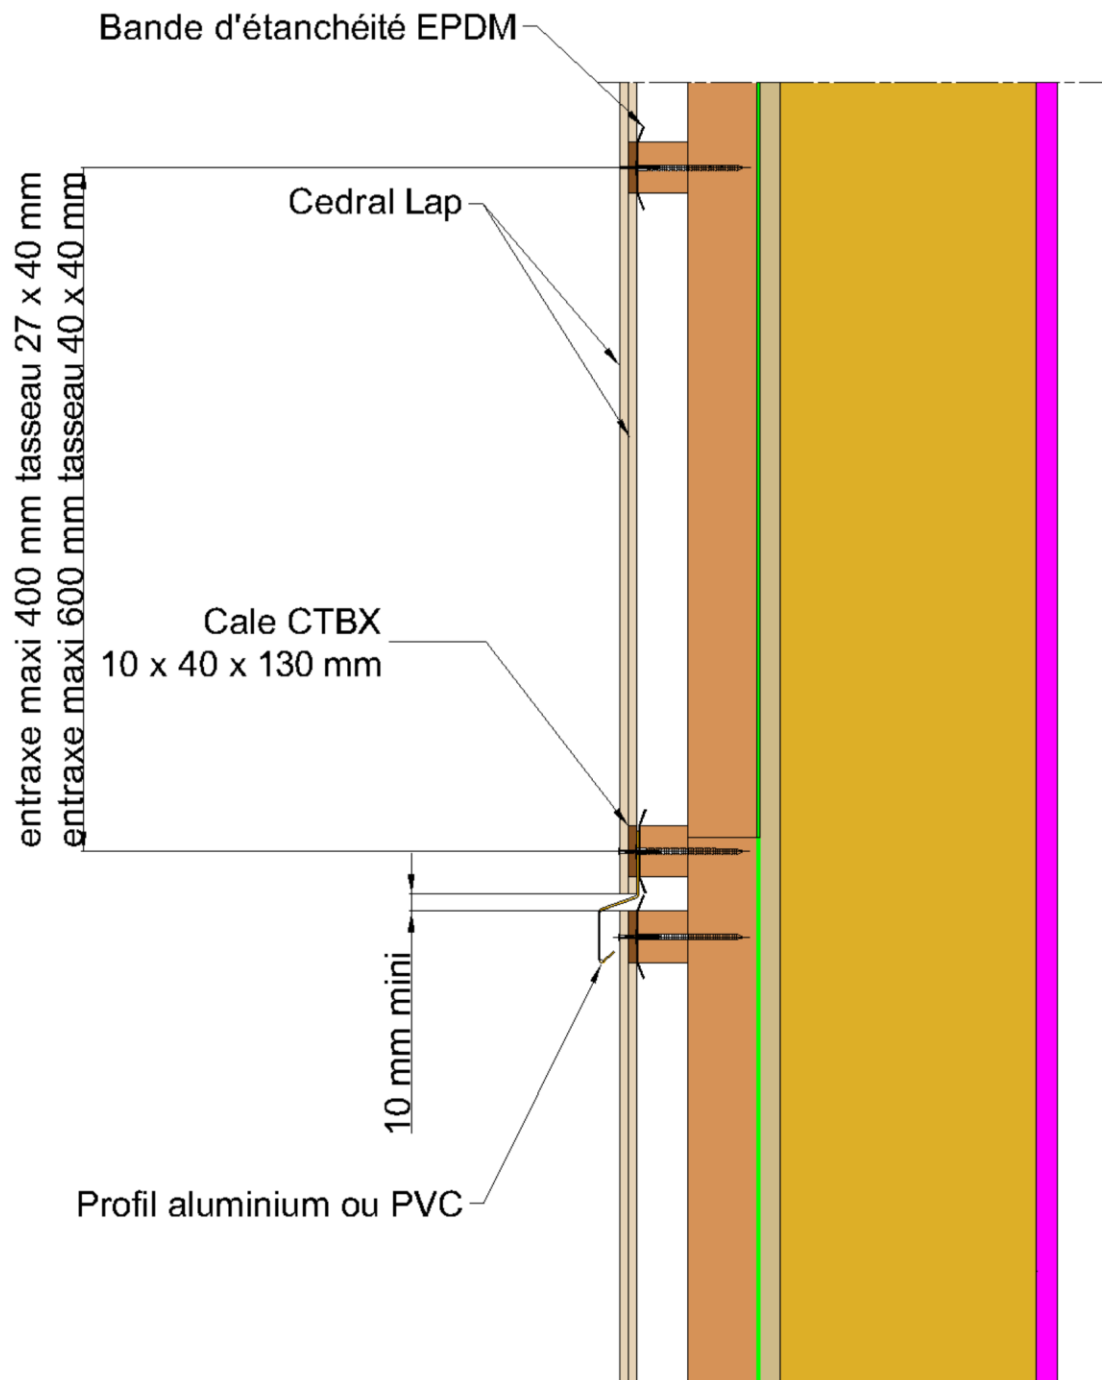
Joint horizontal en pose verticale (tous les 3.6 m maximum)
